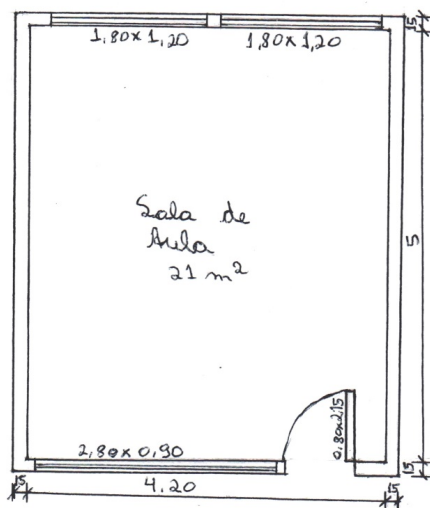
Alunos desenhando a planta baixa da sala de aula
